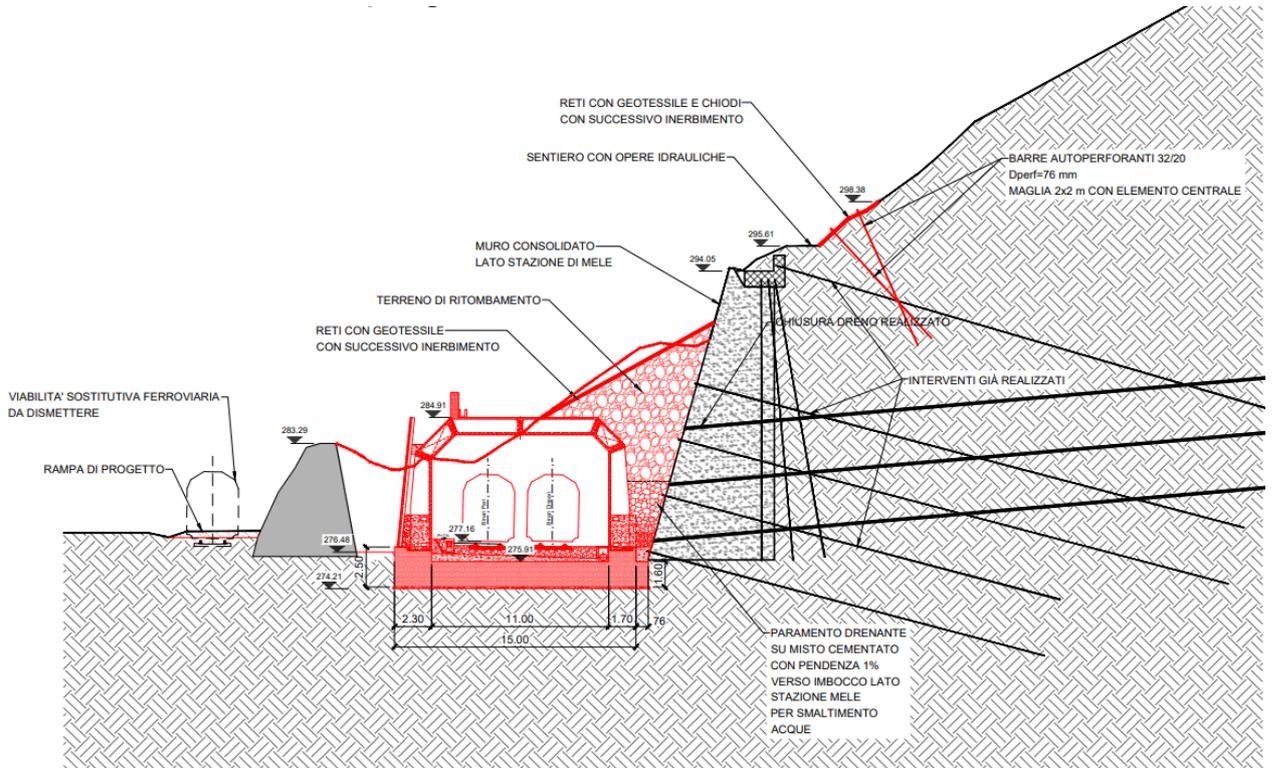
Situazione post operam – Sezione BB (vedere elaborati di progetto allegati)
